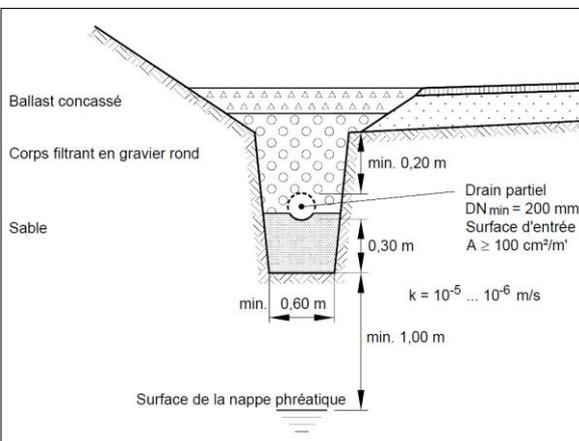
Type 3c – Tranchée drainante avec drain partiel
